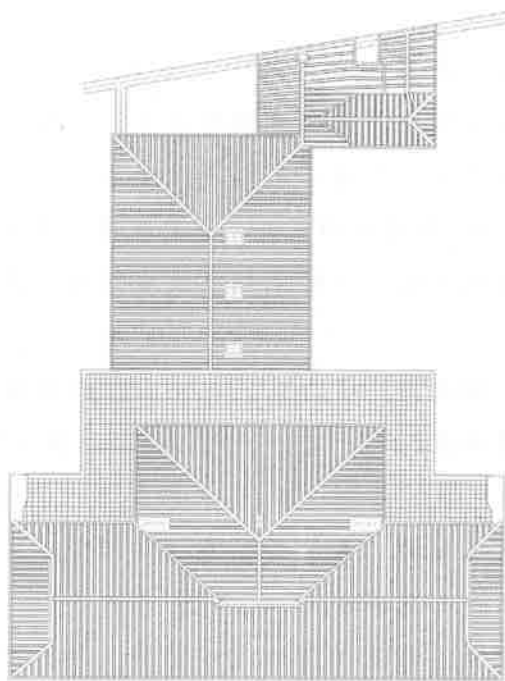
領事官邸屋頂平面圖（資料來源：參考文獻3）
